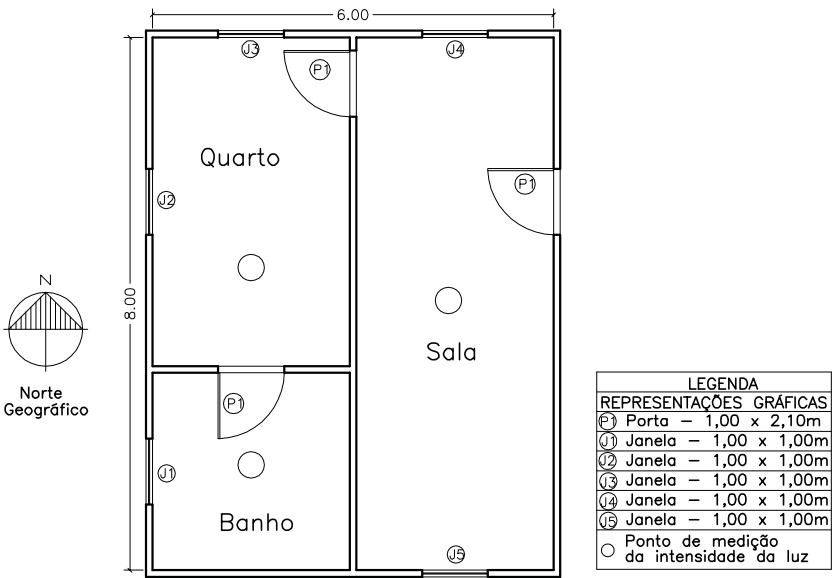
Casa Original – Estudo de Caso 2 – Planta Baixa
